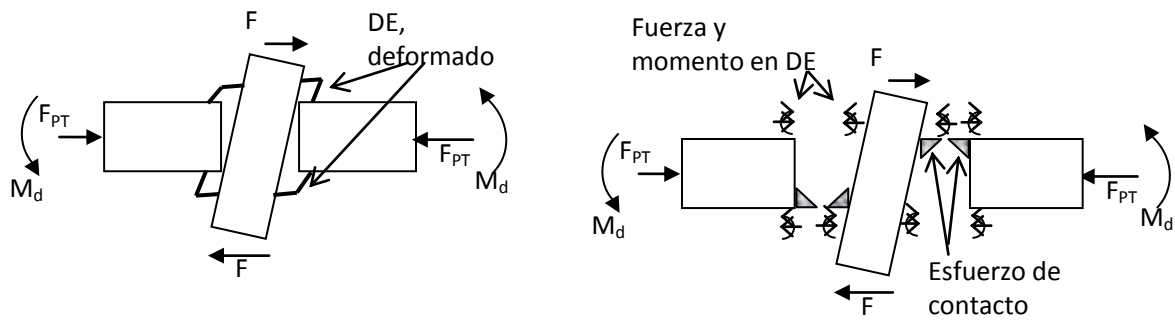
Conexión viga-columna con MPDE después que se abre: ensamblaje completo y diagrama de cuerpo libre
